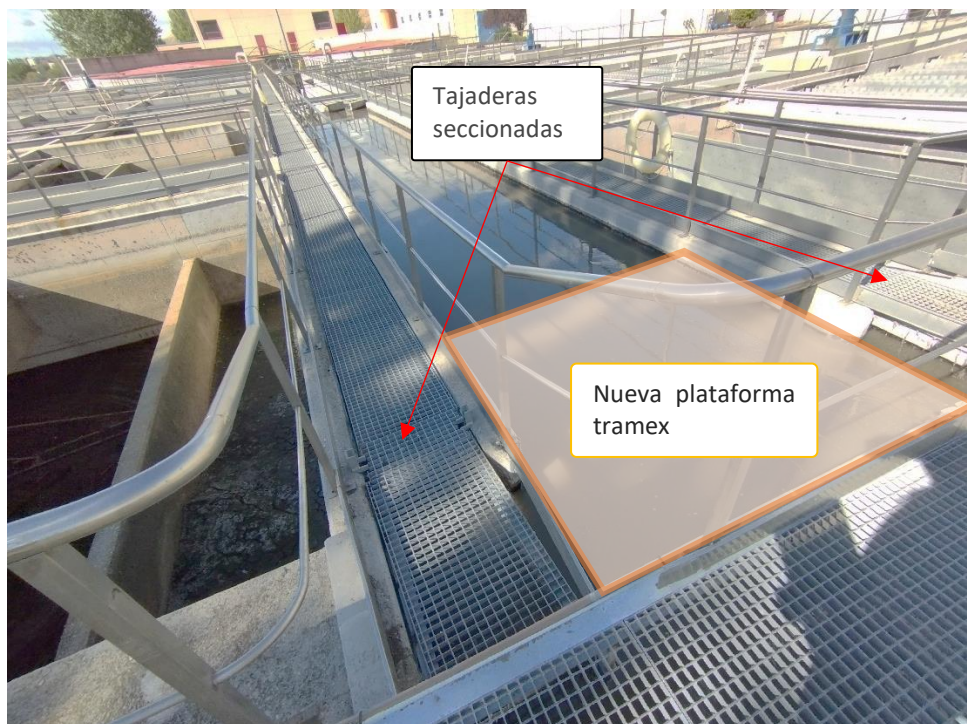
Tajaderas actuales de entrada a decantación primaria. Zona 1.
